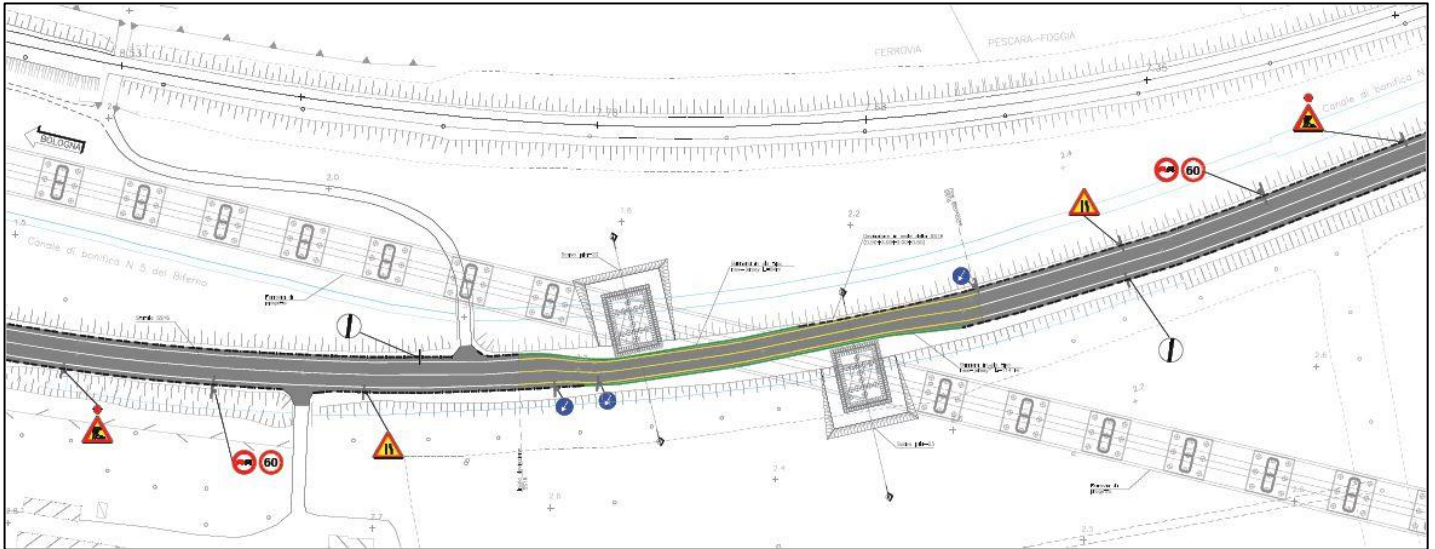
Planimetria segnaletica provvisoria e barriere di sicurezza
